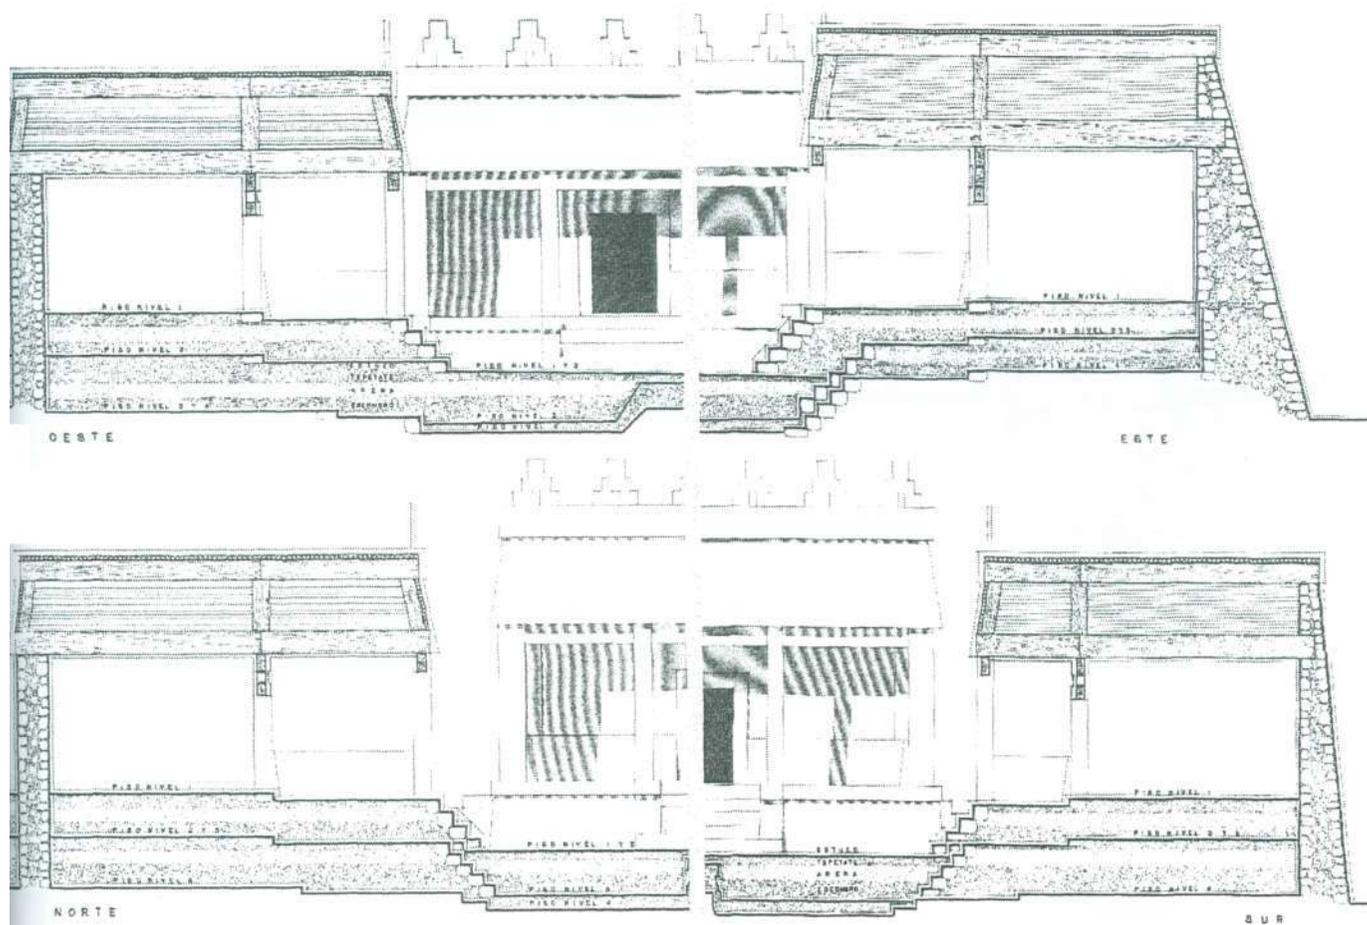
Primeiro nível de construção no pátio central de Tetitla.
